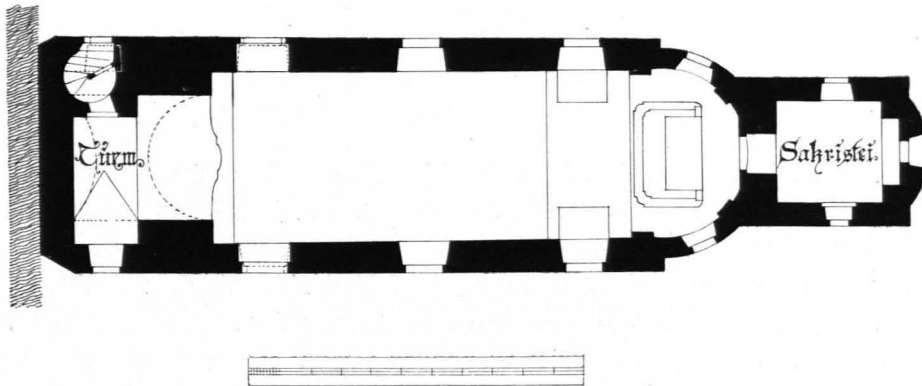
Groß-Poppen, Pfarrkirche, Grundriß 1:250 (S. 174)
